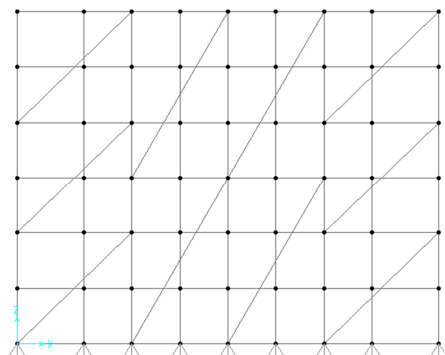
Configuração dos Planos de Contraventamento Vertical Com Elementos de Contraventamento Grandes
